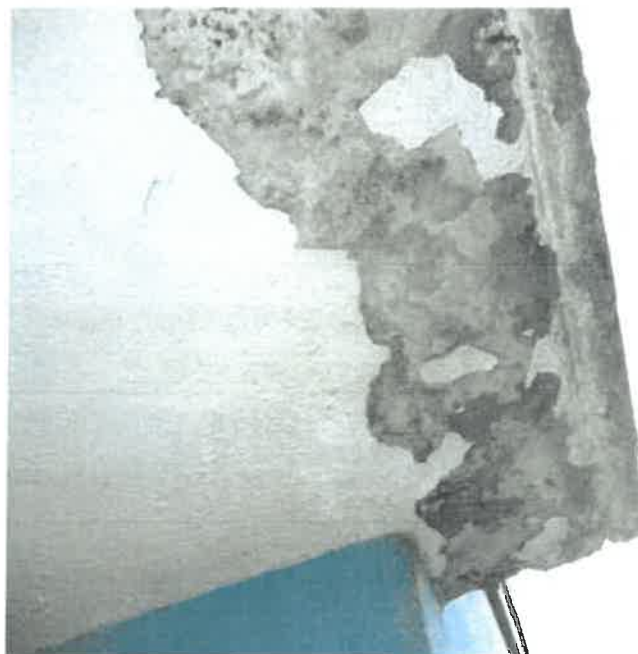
Uszkodzona otulina betonowa zbrojenia zebra wspornikowego balkonu w mieszkaniu nr 62 w budynku nr 24
